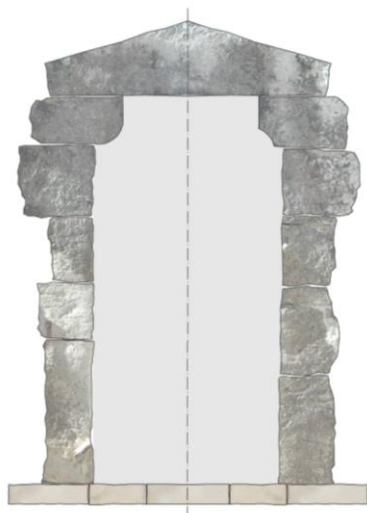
Portale con architrave monolitico triangolare in pietra grezza. Blocchi all’imposta dell’arco in pietra grezza sagomati concavi o convessi alla base delle spalle in pietra grezza, spalle in blocchi di pietra irregolarmente squadrate. Soglia in blocchi di pietra irregolarmente squadrate.
